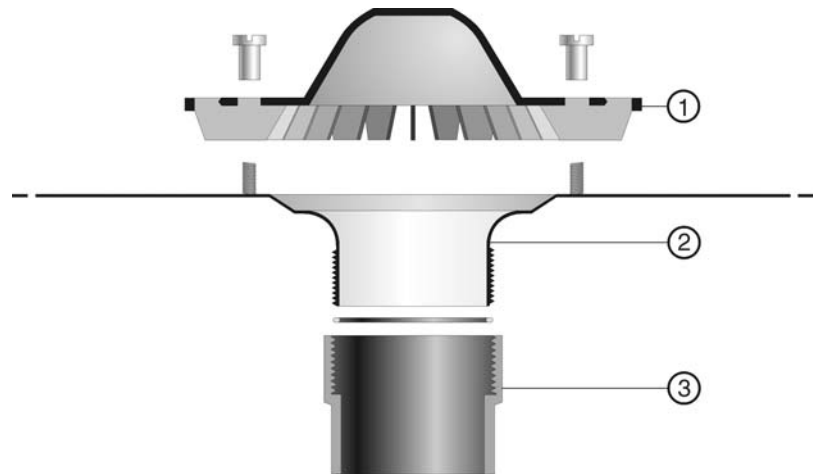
Installatievoorbeeld Wavin QS 75 – type klemmontage voor dakbedekkingen van PVC, EPDM of bitumen
